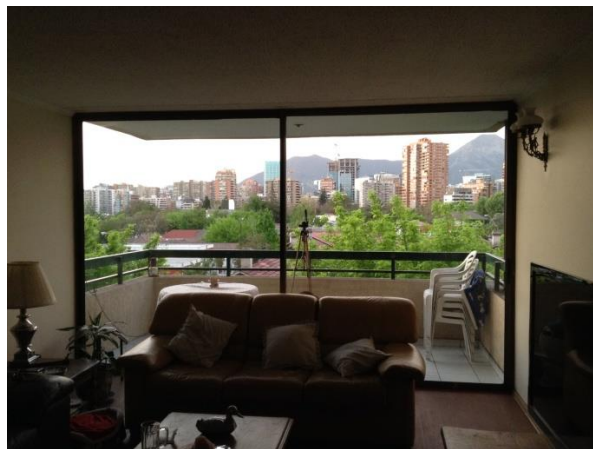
Vista interior de la fachada utilizada para el ensayo.
